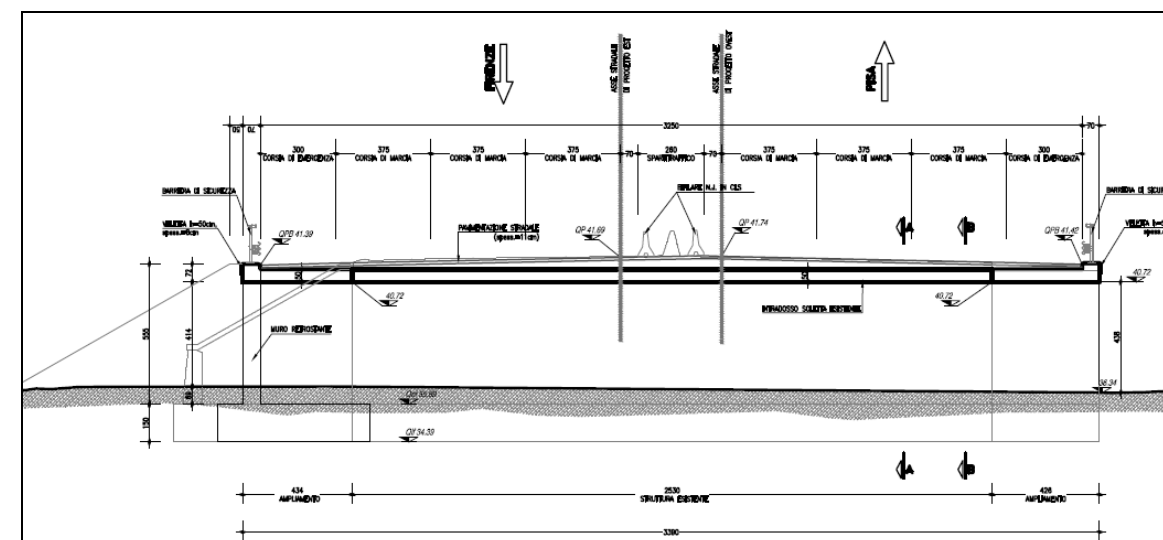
Sottovia S.C. Cantone. Sezione trasversale
